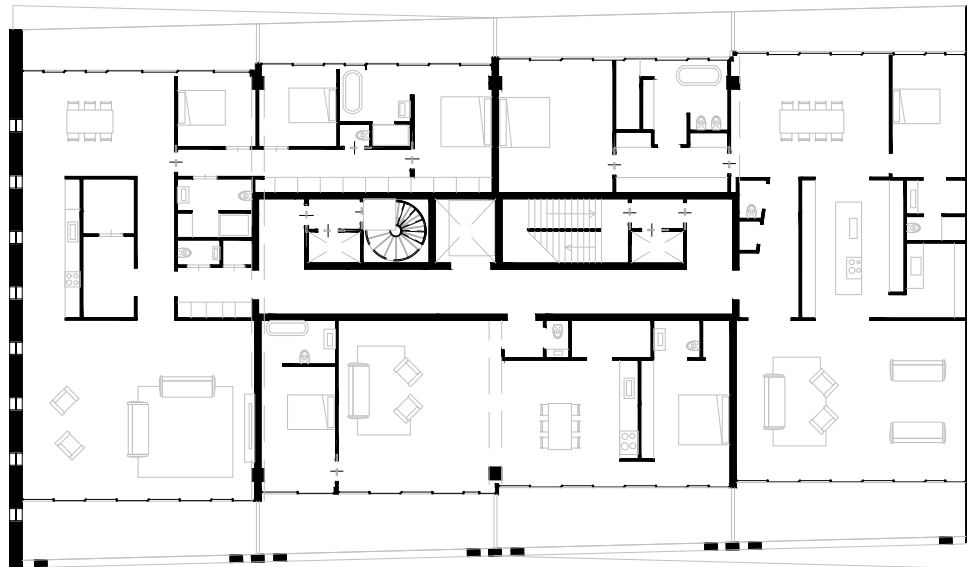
Plano de planta prototipo con tres viviendas del edificio Patch 22 a escala 1:200
